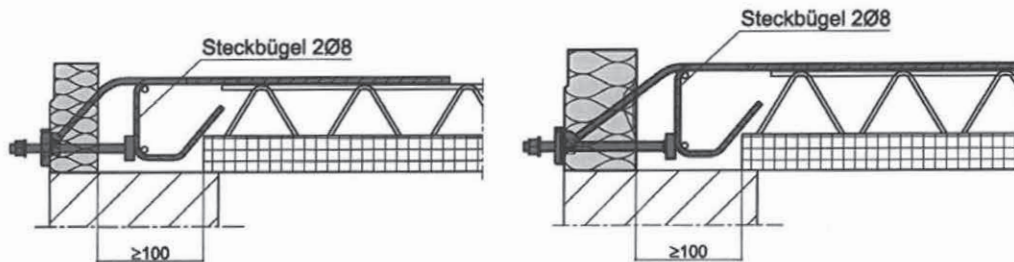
Bauseitige Anschlussbewehrung für Schöck Isokorb® Typ KSXT20 V10 und KSXT20 V12
